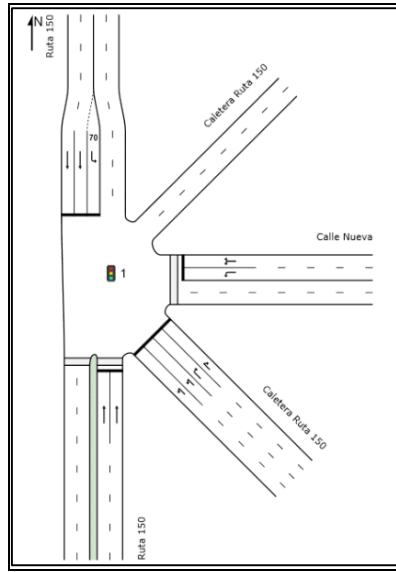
Layout Modelación Situación Con Proyecto intersección Outlet. Fuente: Sidra Intersection
